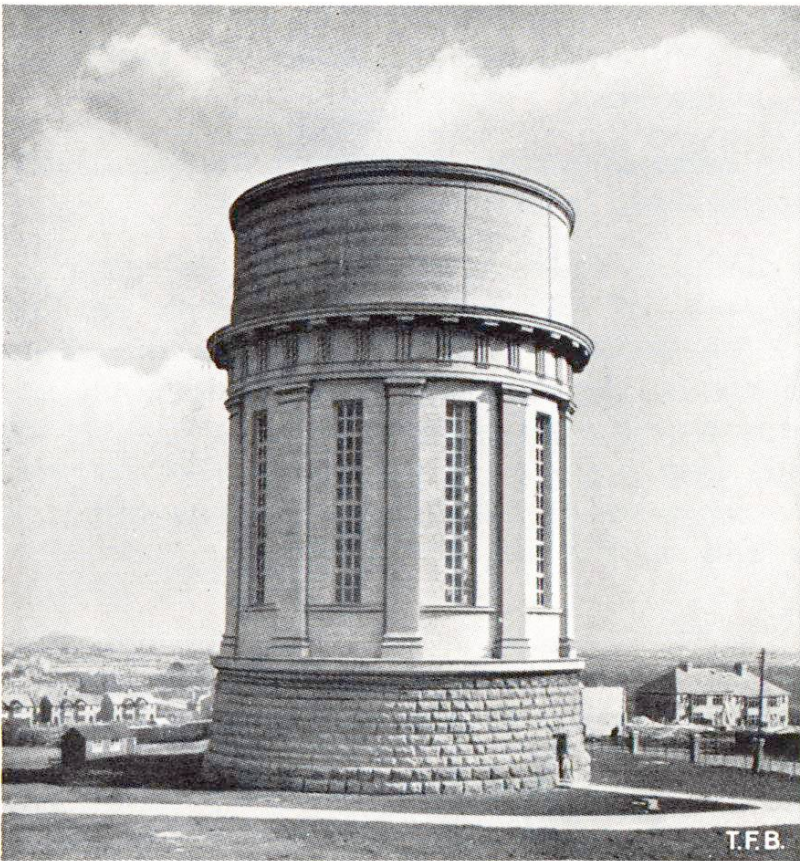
Tour d'eau à Blackpool, construite entièrement en béton et béton armé. La base est constituée par des blocs de béton fendus. Architecte A. C. Dickie, M. A. (Concrete Craft, C. C. A., Londres)
